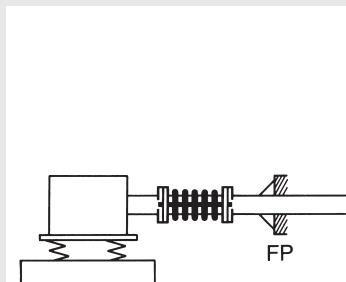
Боковой компенсатор на вибрирующем агрегате
